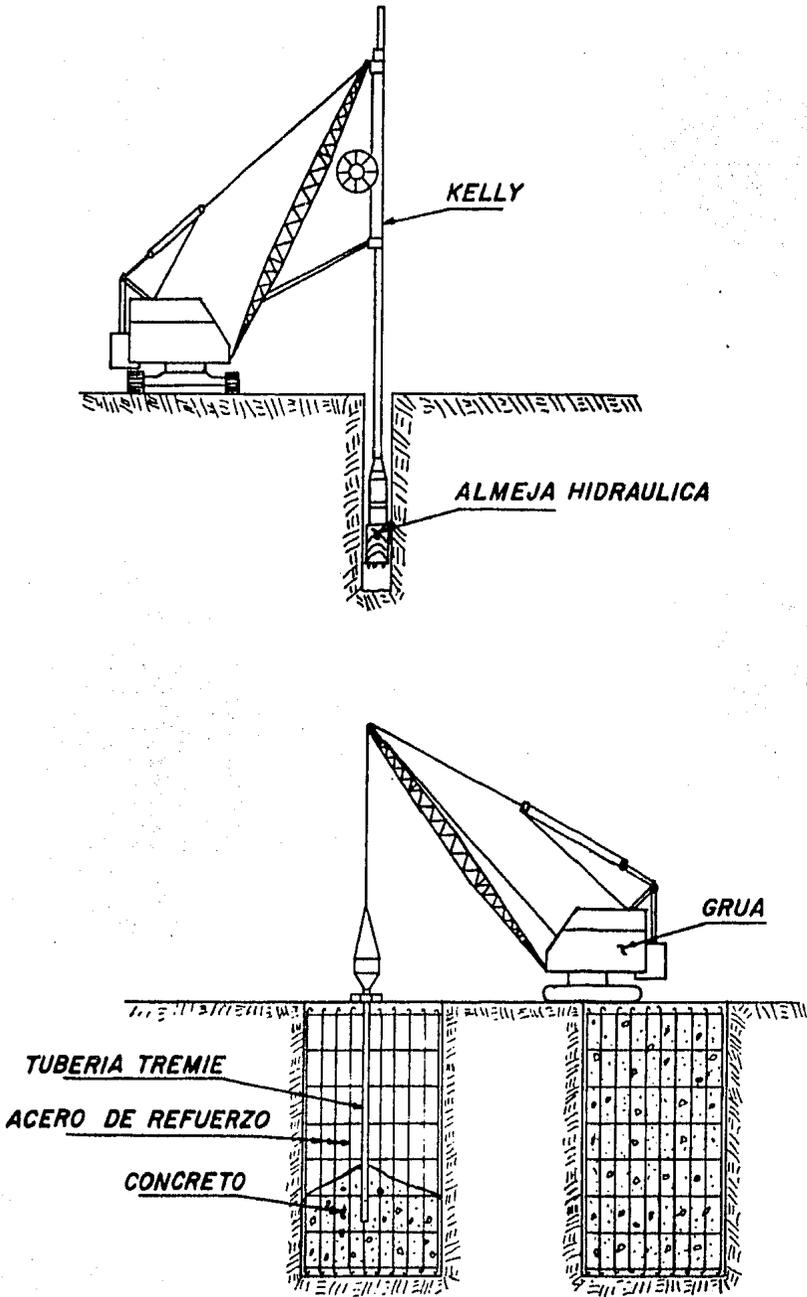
EXCAVACION Y COLADO DE UN MURO TABLESTACA
